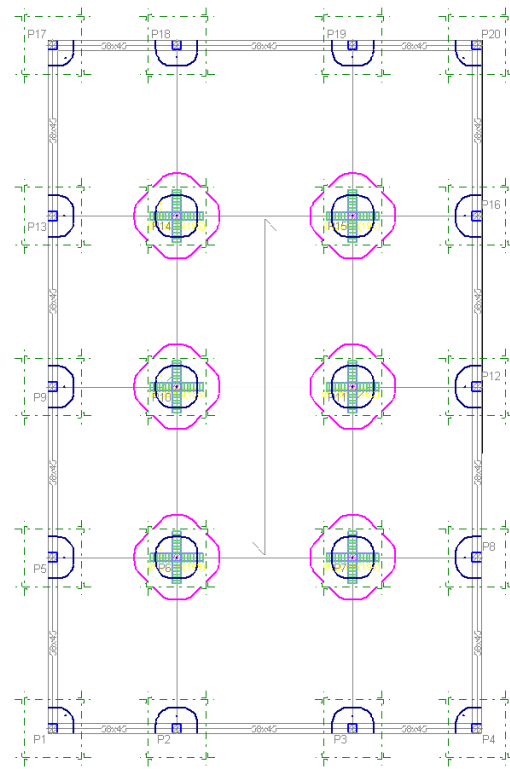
Planta de perimetros de punzonamiento pilares losa.
